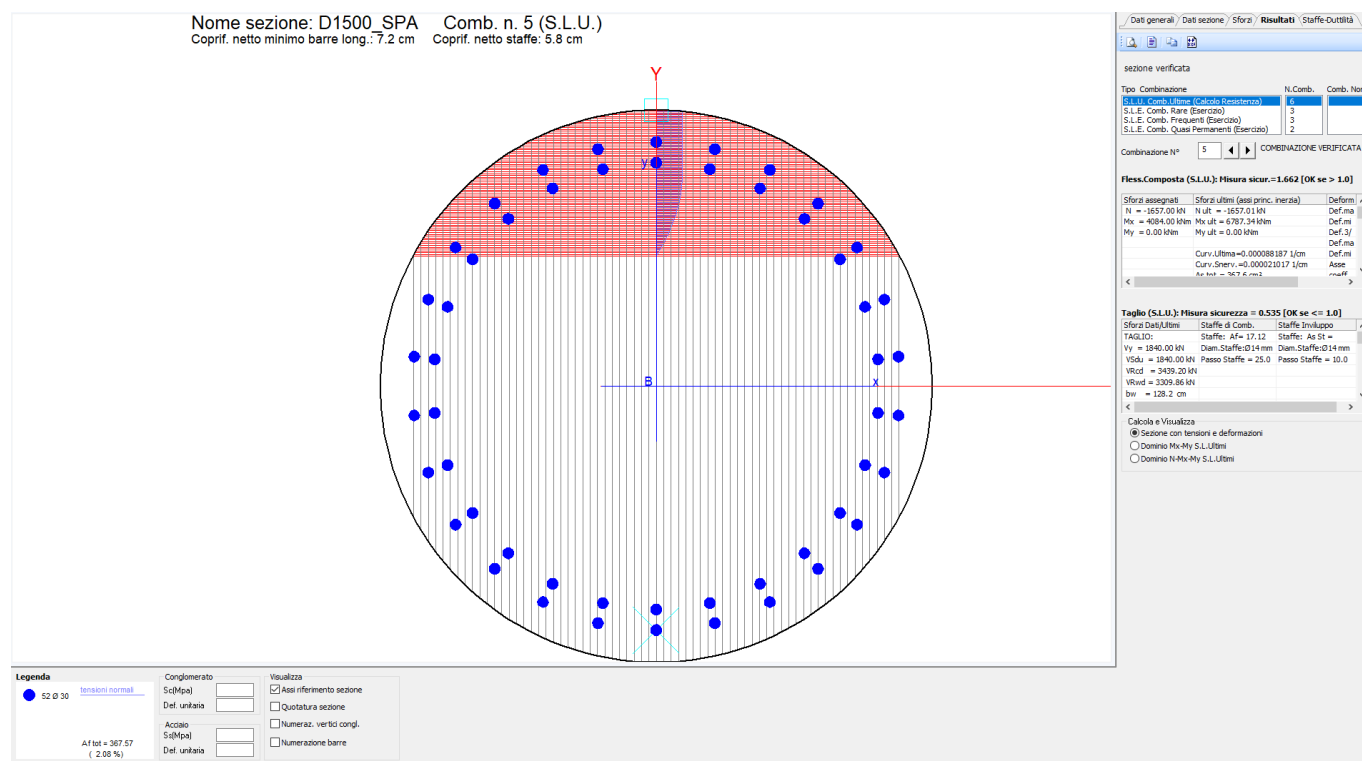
Verifica strutturale palo D=1500mm spalla A
